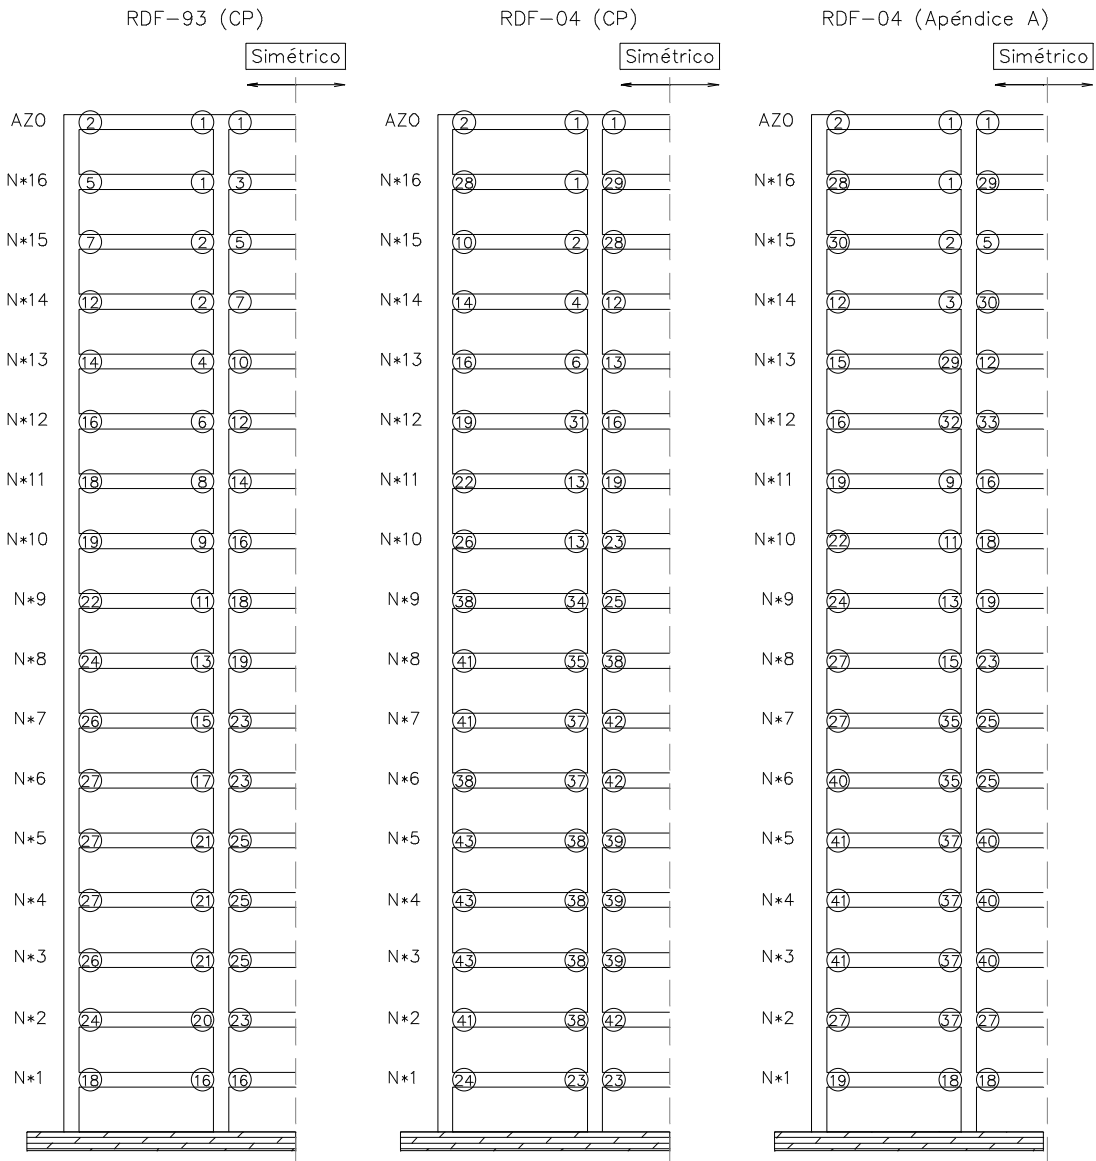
Ubicación de los tipos de armados de los extremos de las vigas del eje 2, estructuras de 17 niveles, diseños en zona III (RDF-93 y RDF-04)
